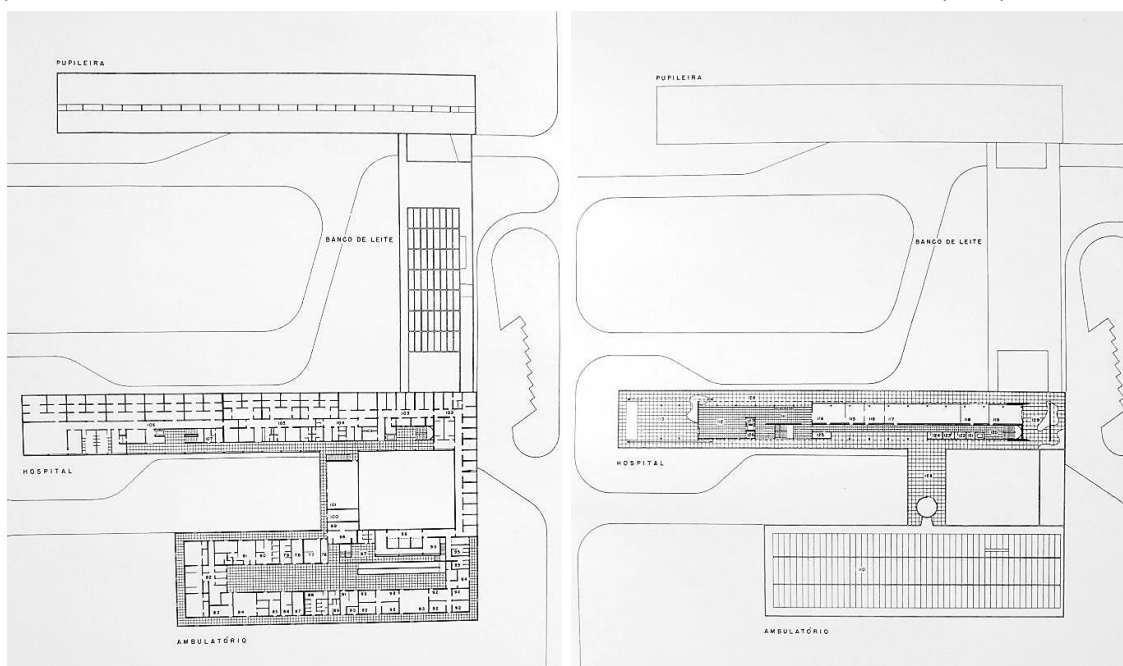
e 170: Planta do térreo da Pupileira e dos subsolos do Hospital e Banco de Leite. Planta do segundo pavimento da Pupileira e térreo do Ambulatório, Hospital e Banco de Leite.
